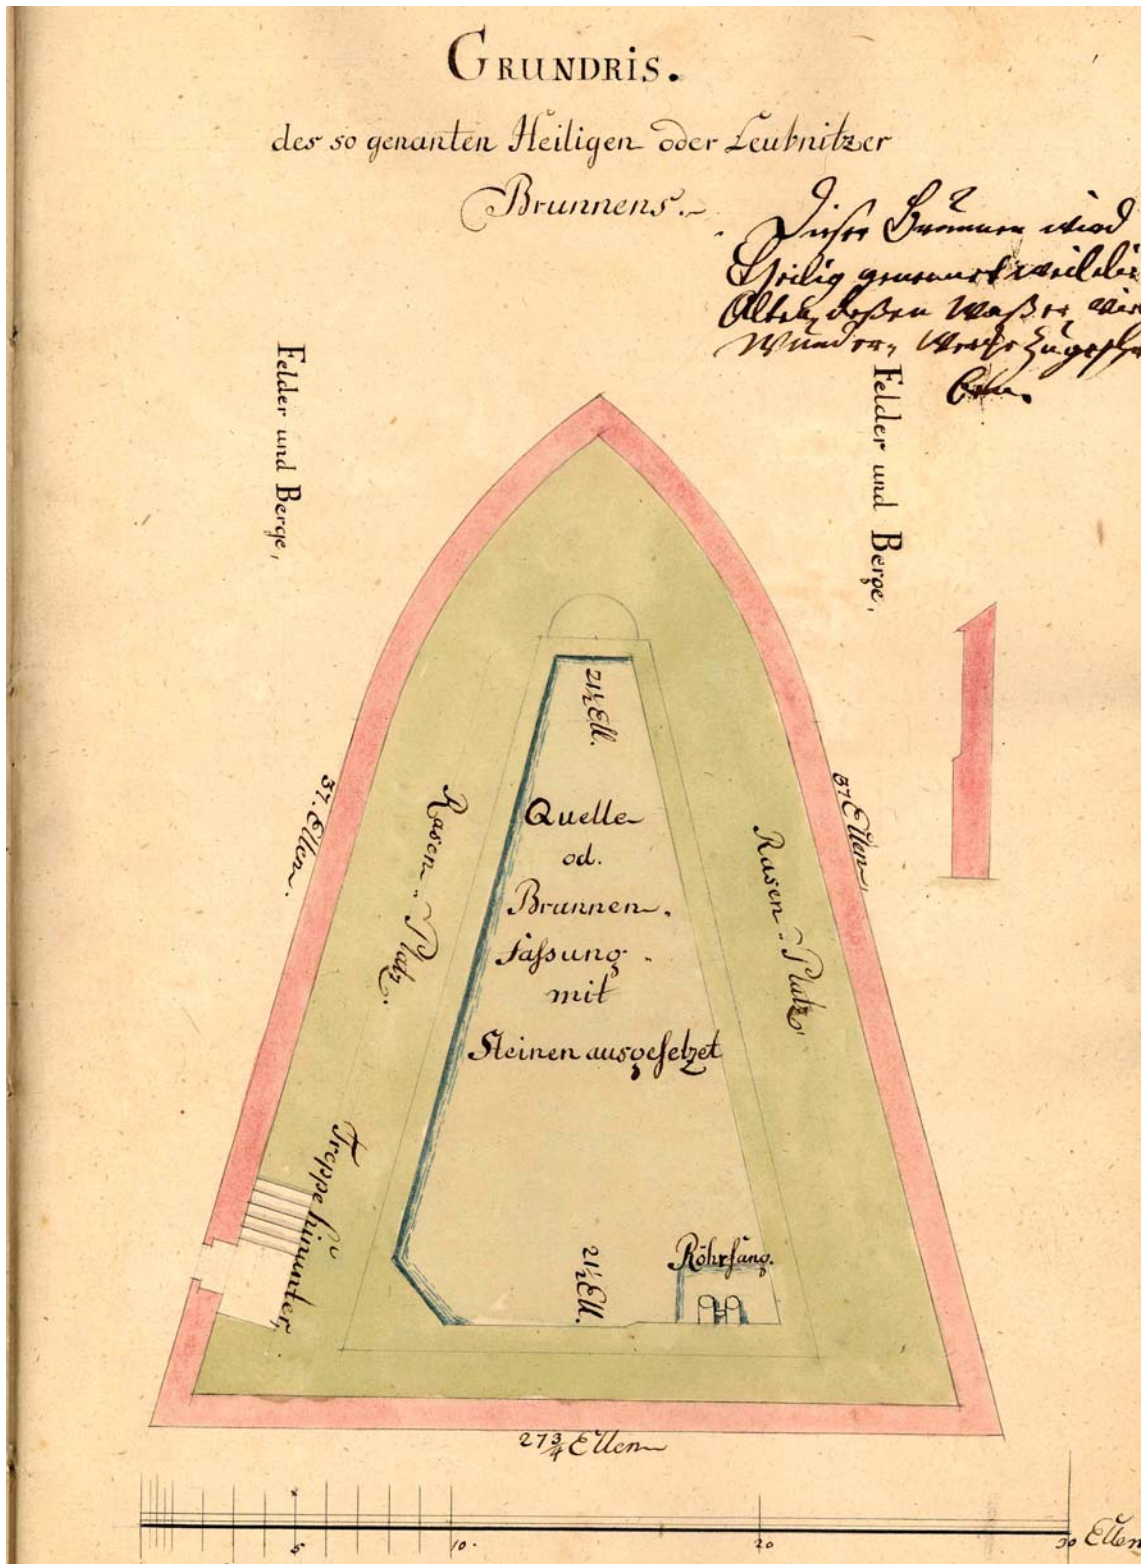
Grundriss des Heiligen Borns 1732
